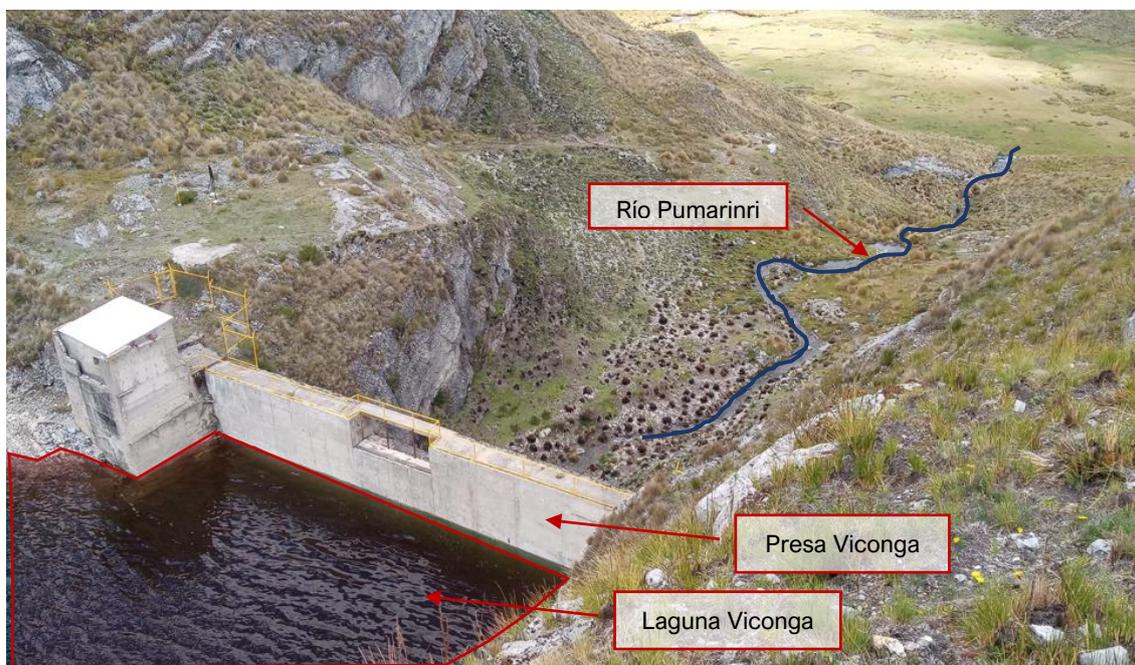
Vista planta de ubicación: Presa Viconga
